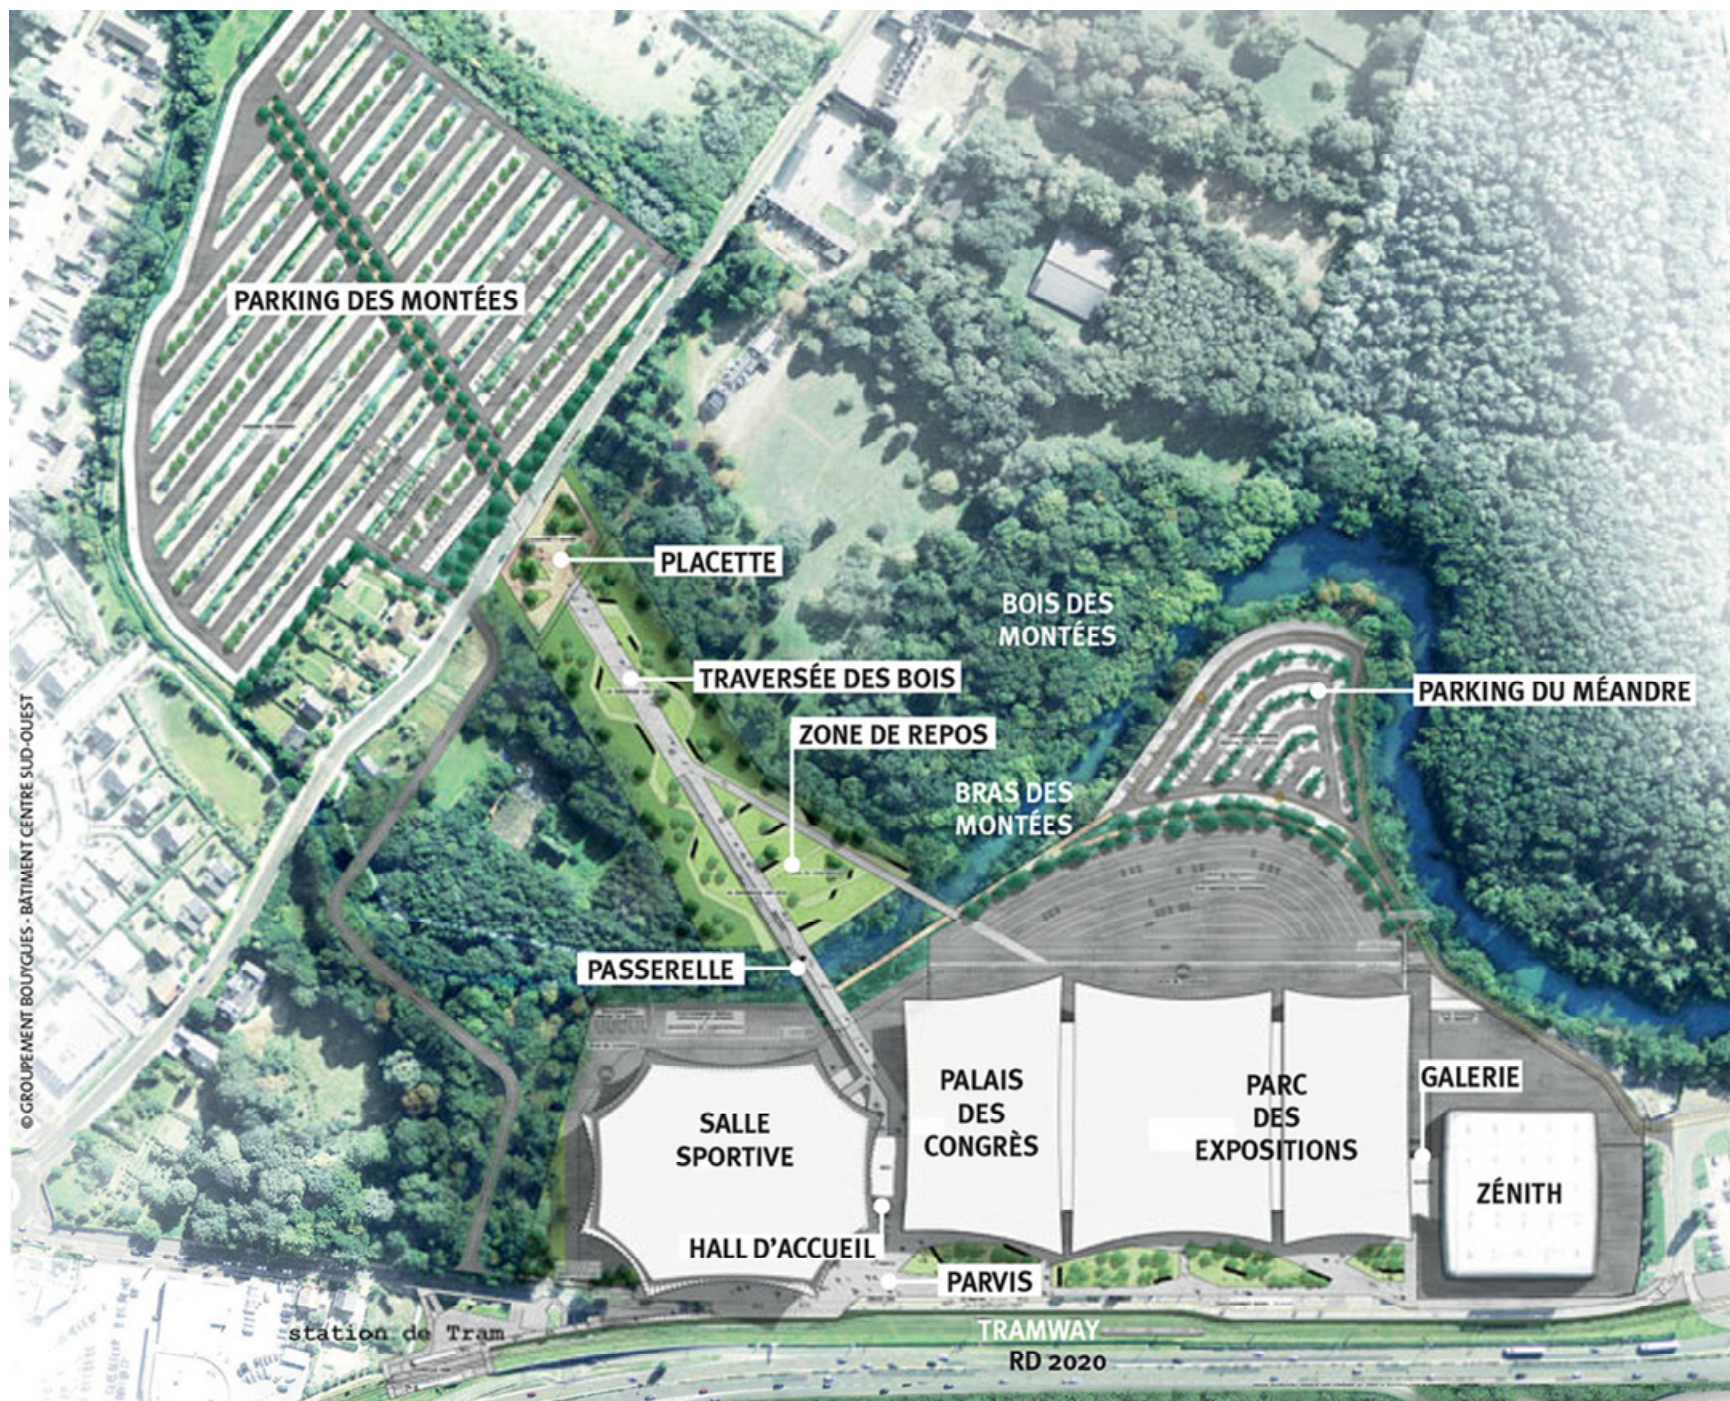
Plan du futur complexe CO'MET. (Source : Orléans métropole)
